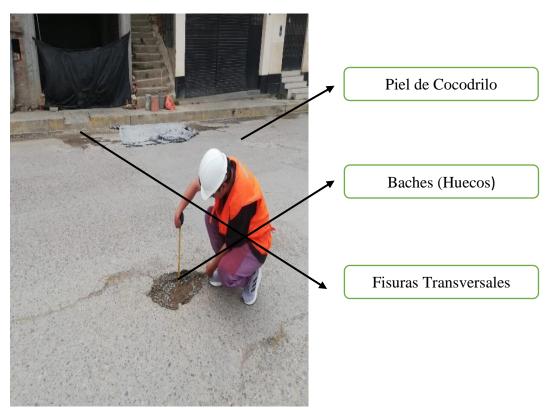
Se visualiza las fallas piel de cocodrilo y fisuras transversales
